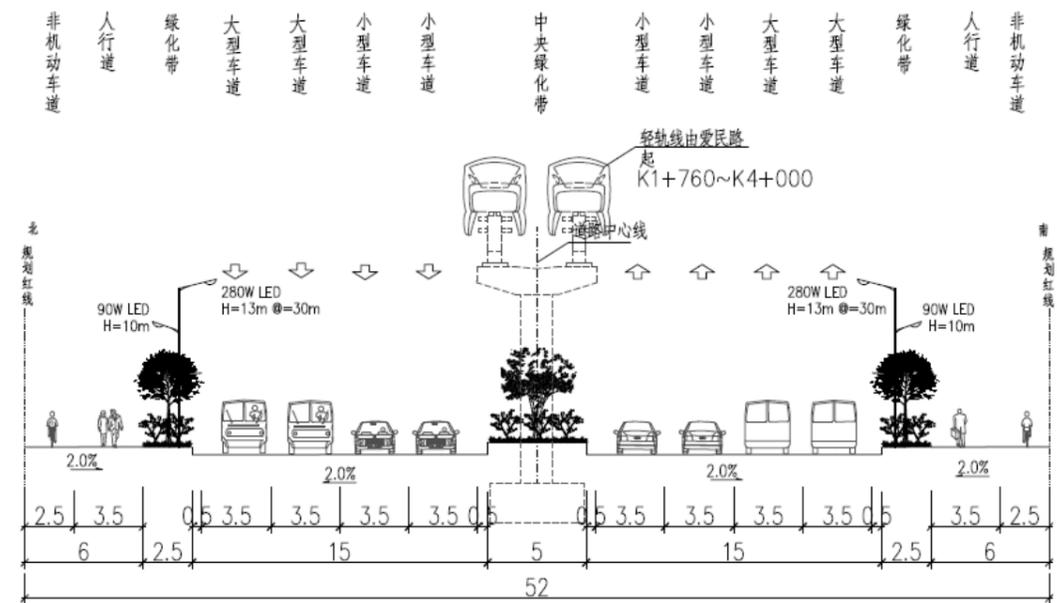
金沙西路西延（K1+140-K4+000）照明横断面图（尺寸单位：m）
